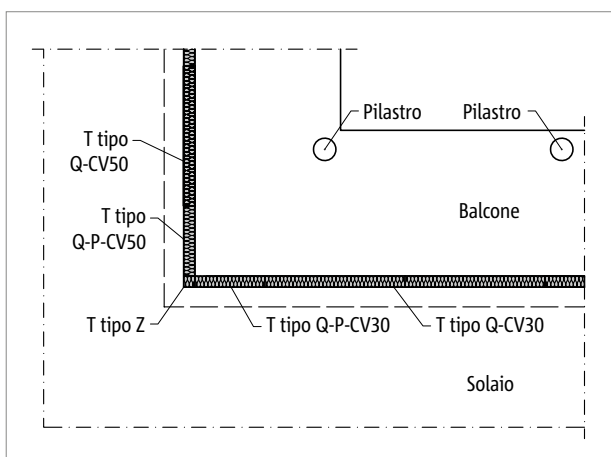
Schöck Isokorb® T tipo Q-P, Q: angolo interno; pianta con balcone in appoggio (non serve inserimento)
